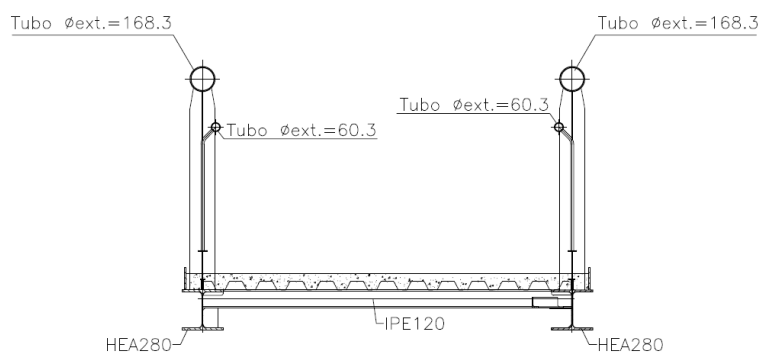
Corte da secção do tabuleiro na zona do vão [25].
